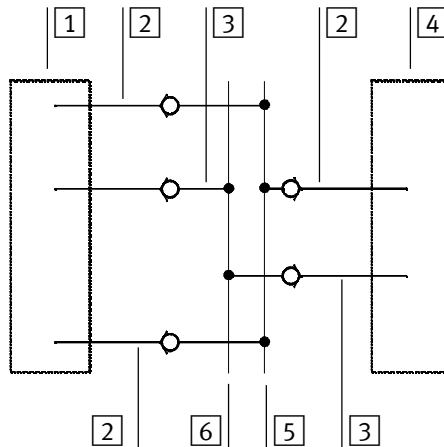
/4: Sammelleitungen mit Rückschlagventilen
